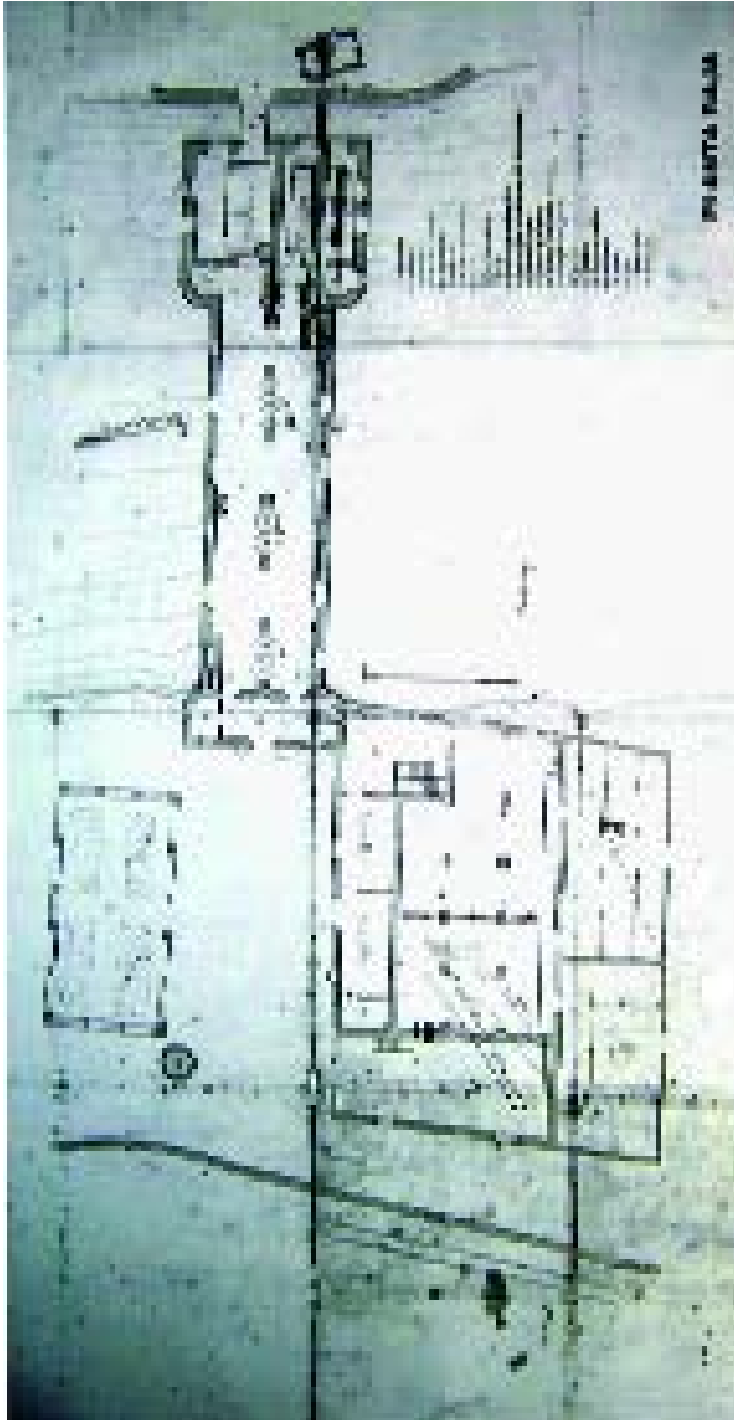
Plano de la planta baja del edificio del Molino del Caño.
